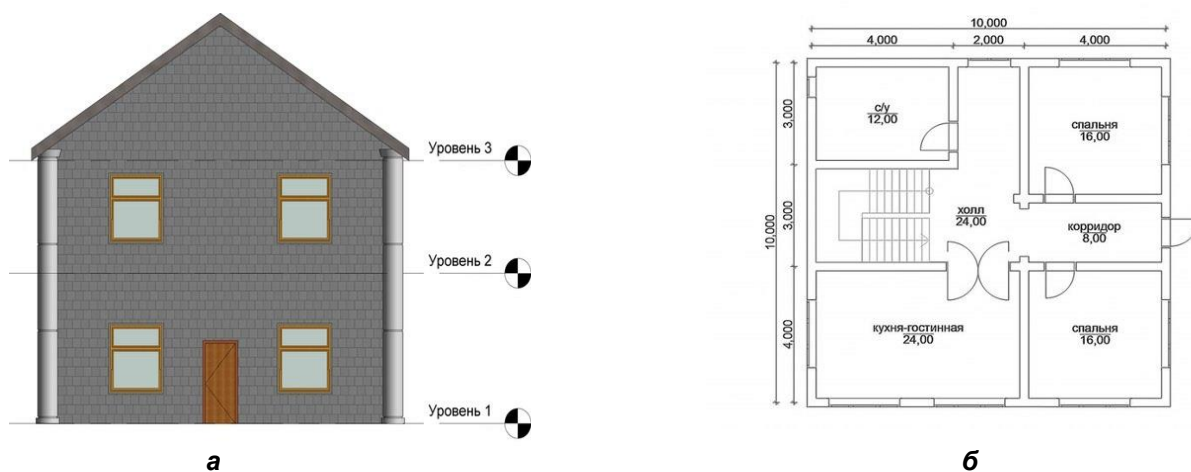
Дом из ППС-25: а – проект фасада; б – план первого этажа
